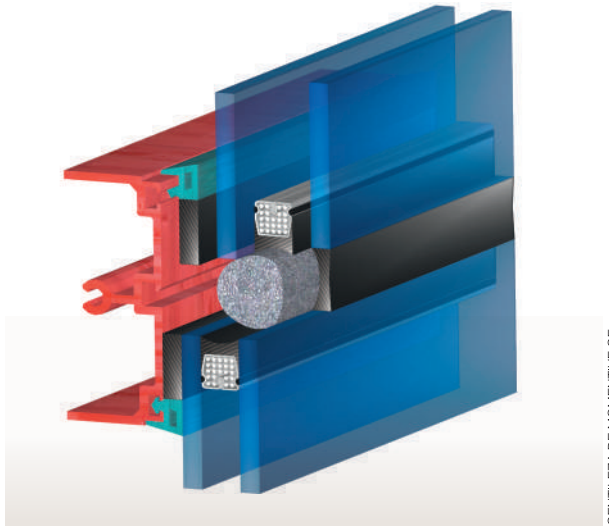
Sección Horizontal típica de muro cortina con silicona.
